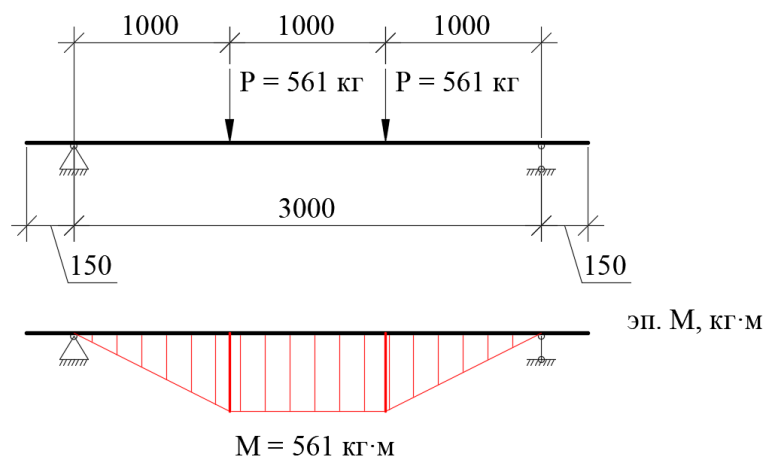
Расчетная схема балки перекрытия
